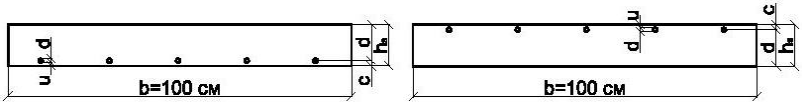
Розрахункові перерізи плити: а) в прольоті; б) на опори
